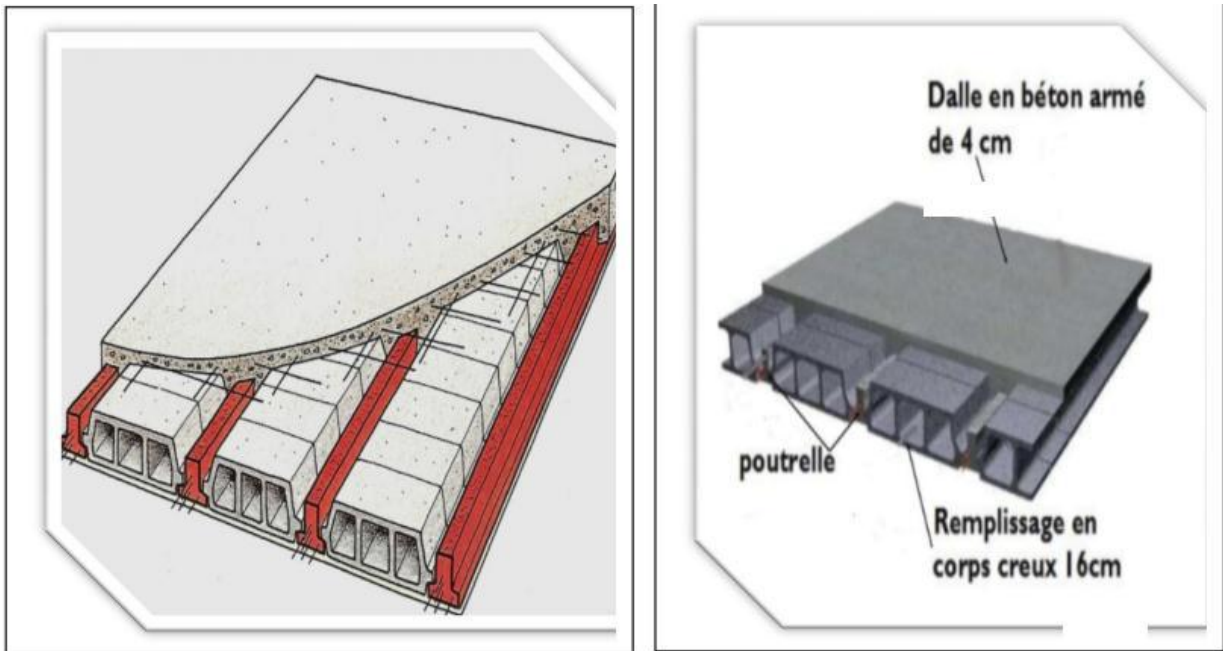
Coupe verticale d'un plancher en corps Creux.
